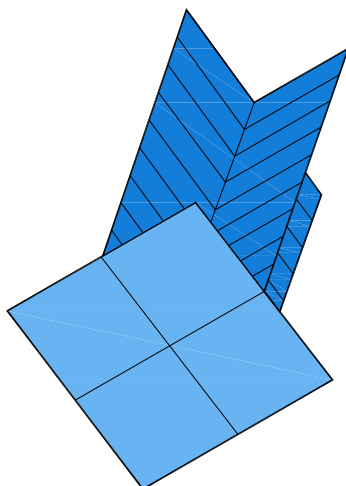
"Detalle de rigidización del apoyo."
